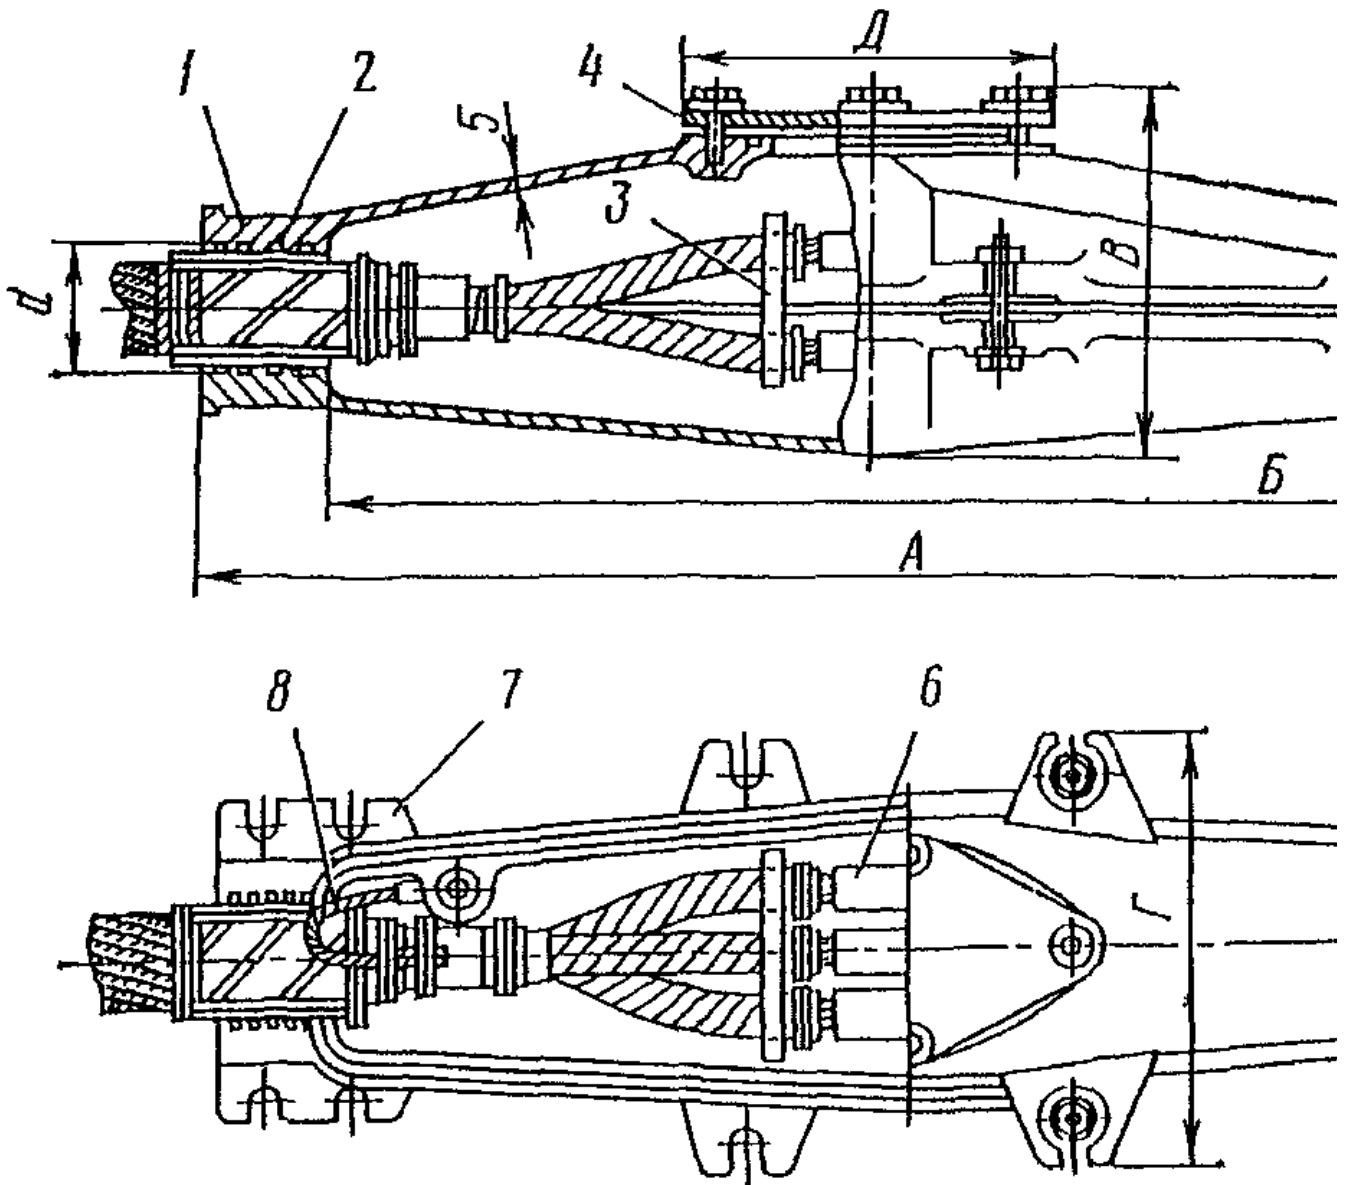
Соединение кабелей напряжением до 1 кВ в чугунной муфте типа СЧ: 1 - верхняя полумуфта; 2 - подмотка из смоляной ленты; 3 - фарфоровая распорка; 4 - крышка; 5 - стягивающий болт; 6 - гильза соединительная; 7 - нижняя полумуфта; 8 - провод заземления
